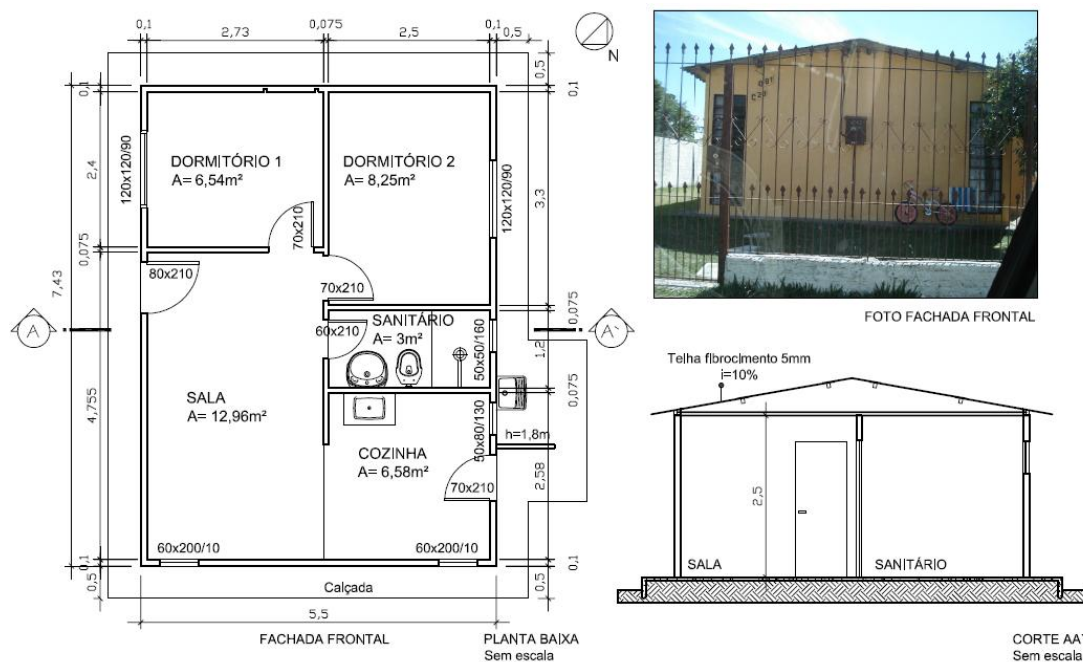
Planta baixa, corte e foto da fachada frontal da habitação da COHAB Tancredo Neves
